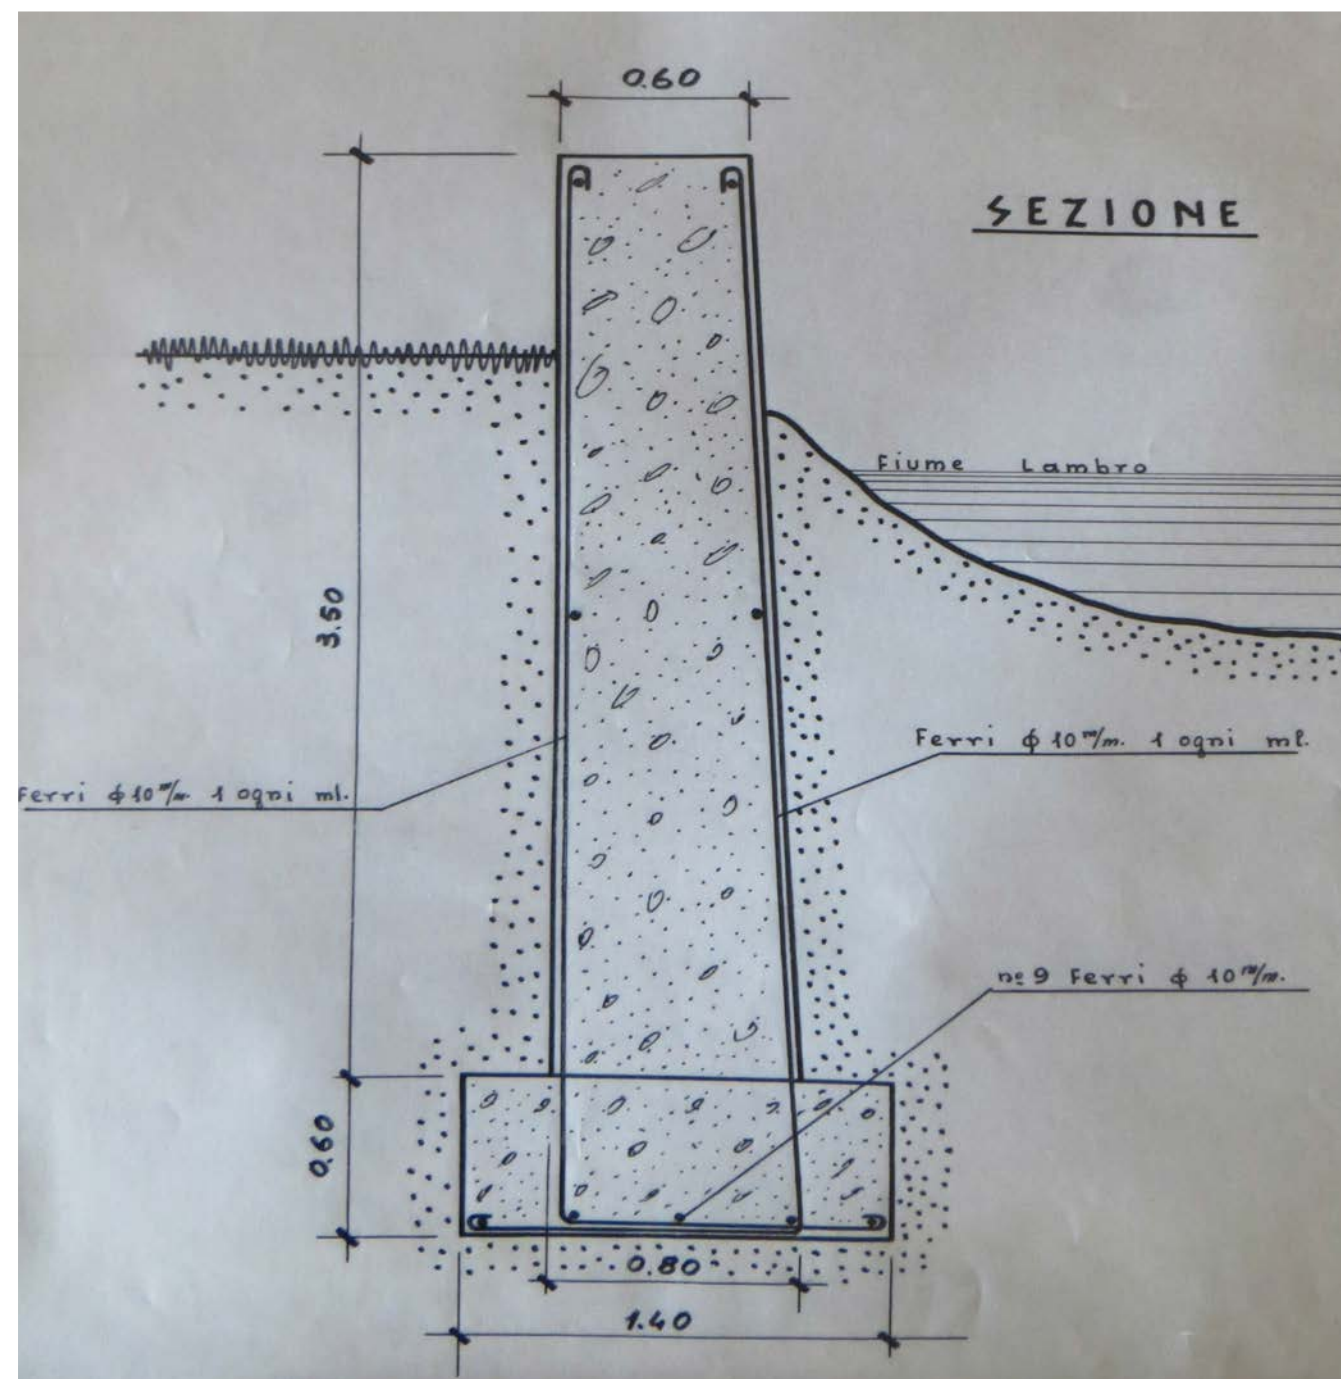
Sezione muro di rettifica sponda destra e sinistra
